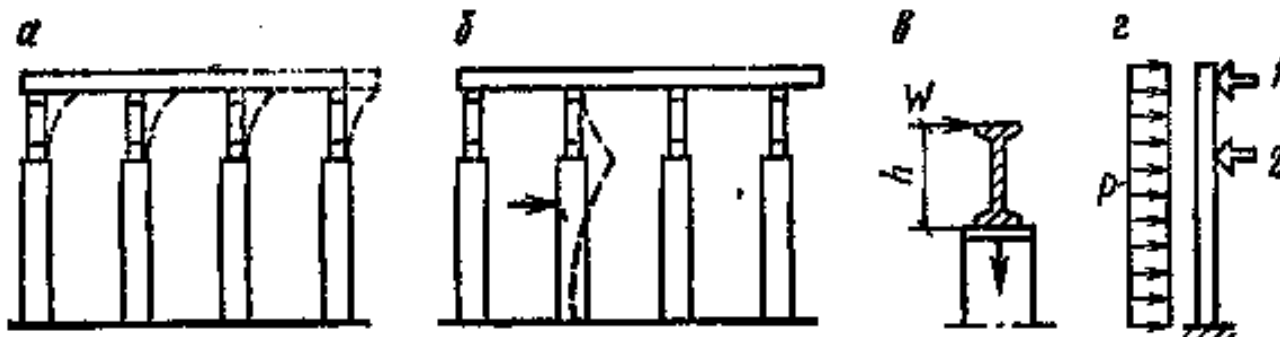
Схема деформаций каркаса здания от горизонтальных нагрузок и расчетные схемы: а – деформации ригелей из плоскости; б - деформация колонны; в - к определению момента, передающегося на стальные опорные листы ригеля; г – расчетная схема колонн торцевой стены; 1 – опирание колонны на покрытие; 2 – опирание колонны на покрытие горизонтальную связевую ферму
